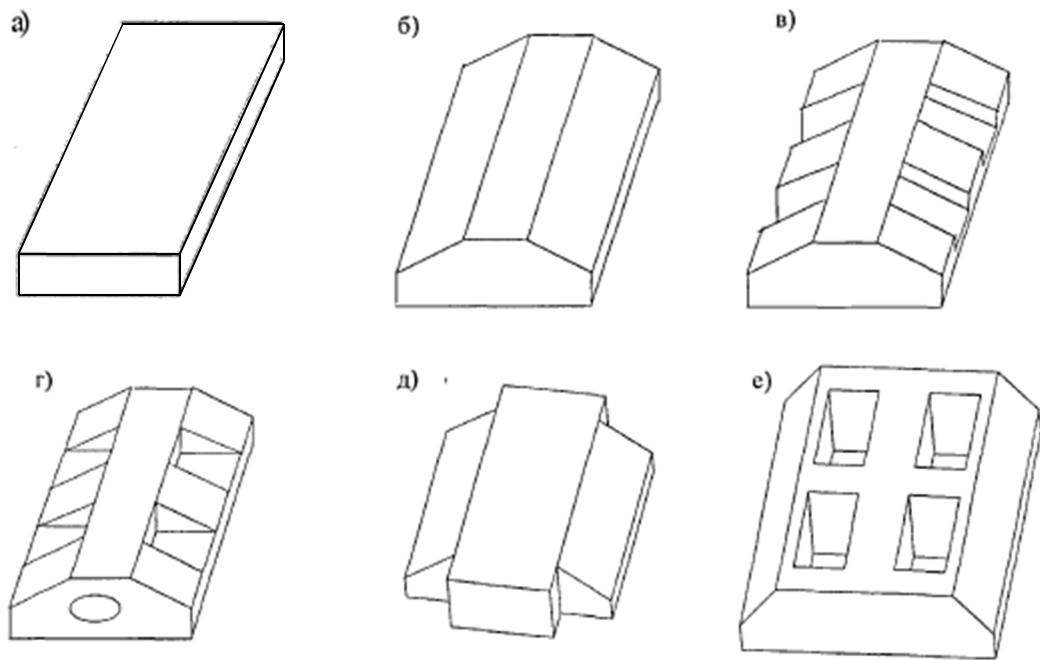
Фундаментні плити стрічкових фундаментів
